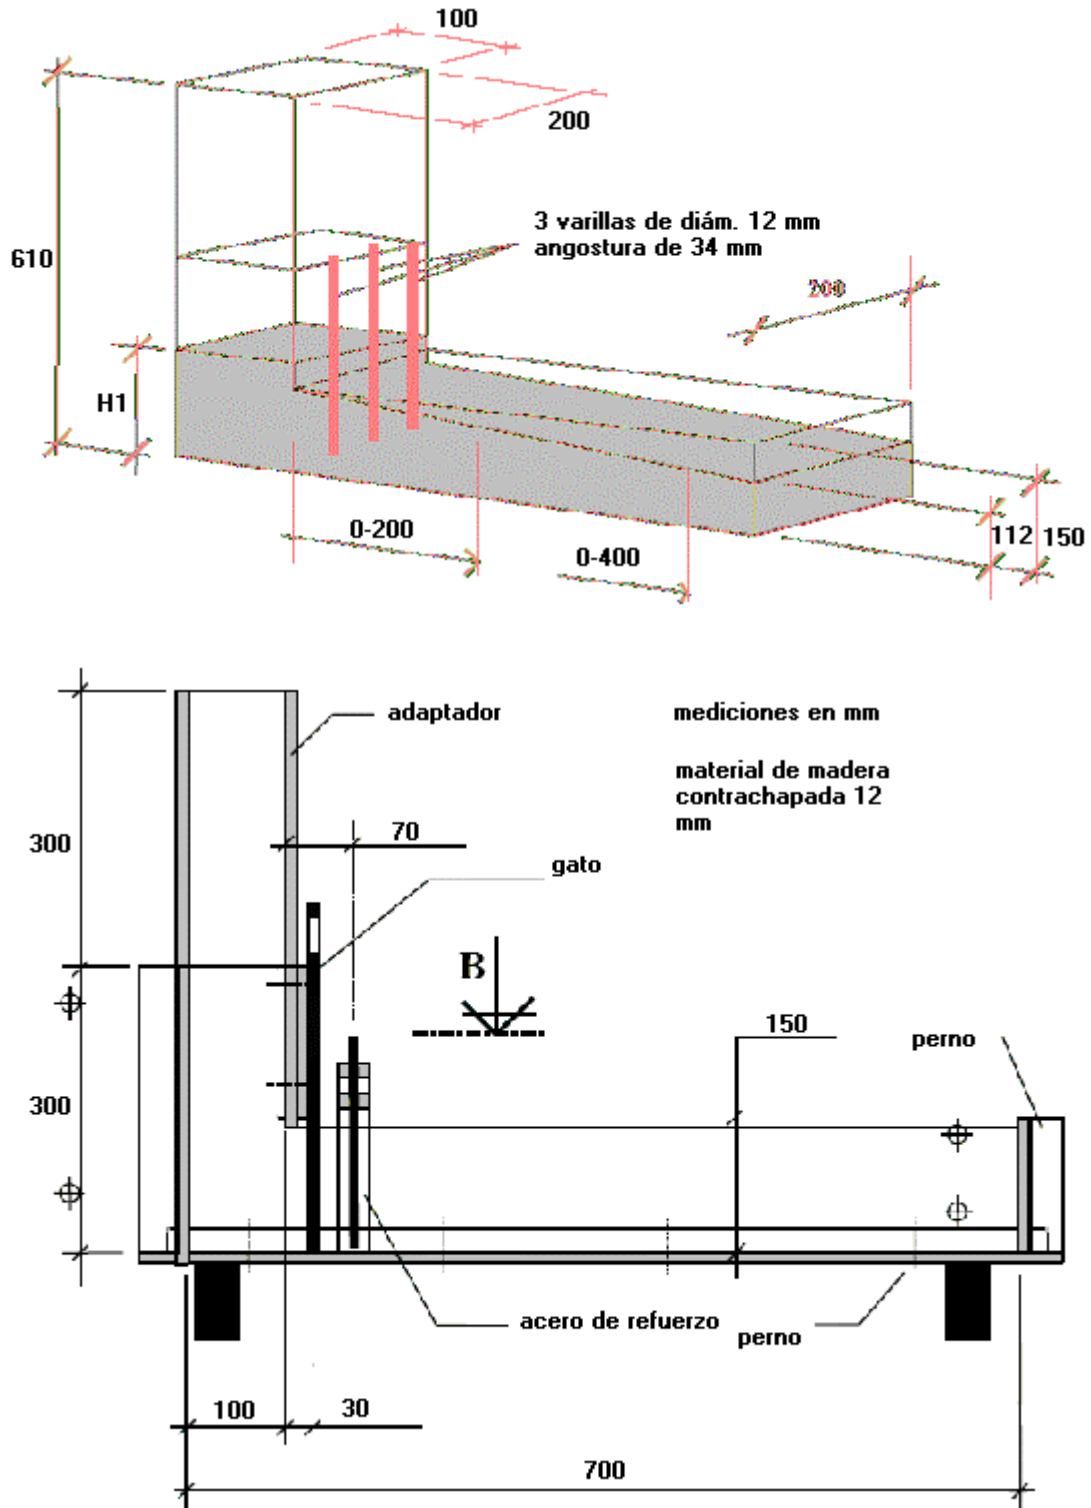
” Prueba caja “L” (L-Box test) corte transversal y longitudinal
